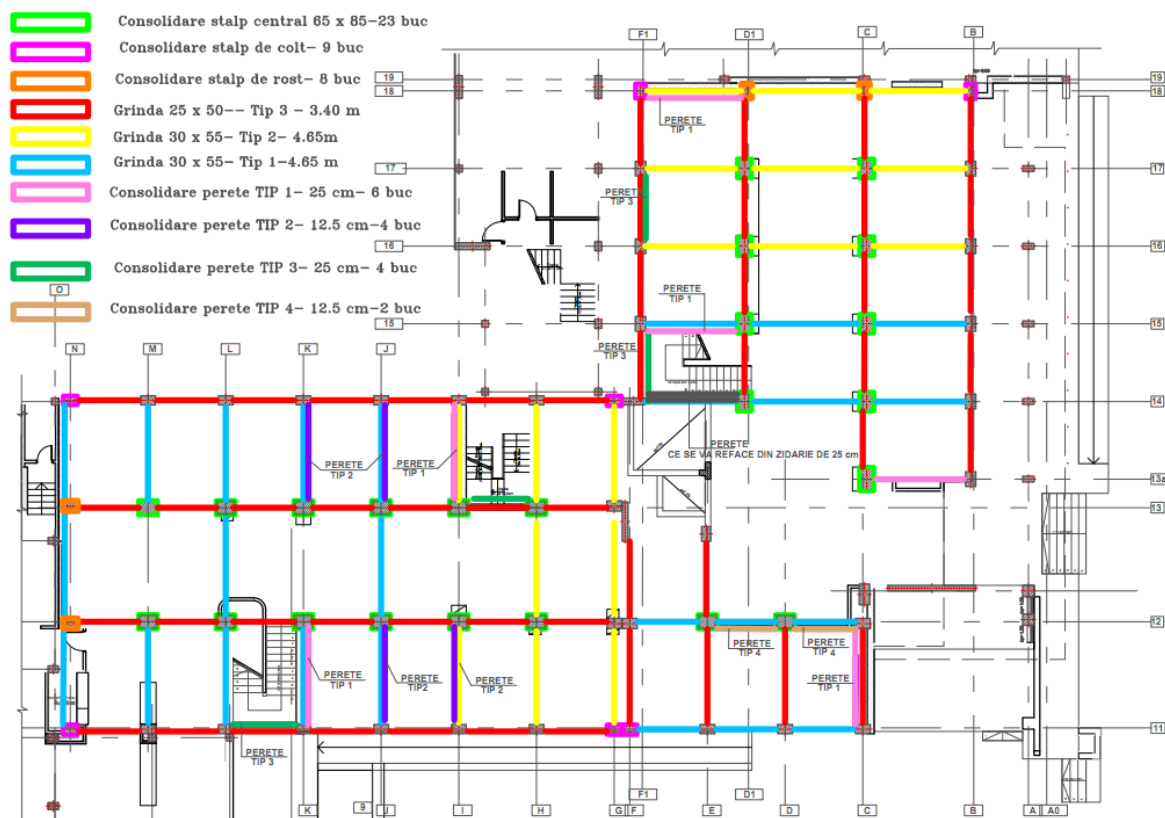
Plan consolidare propus pentru parter și etajul 1
